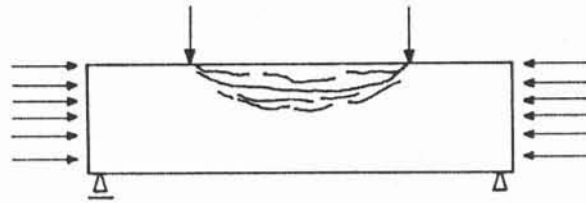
Fissuras provocadas por esforços de flexo-compressão em viga isostática.
